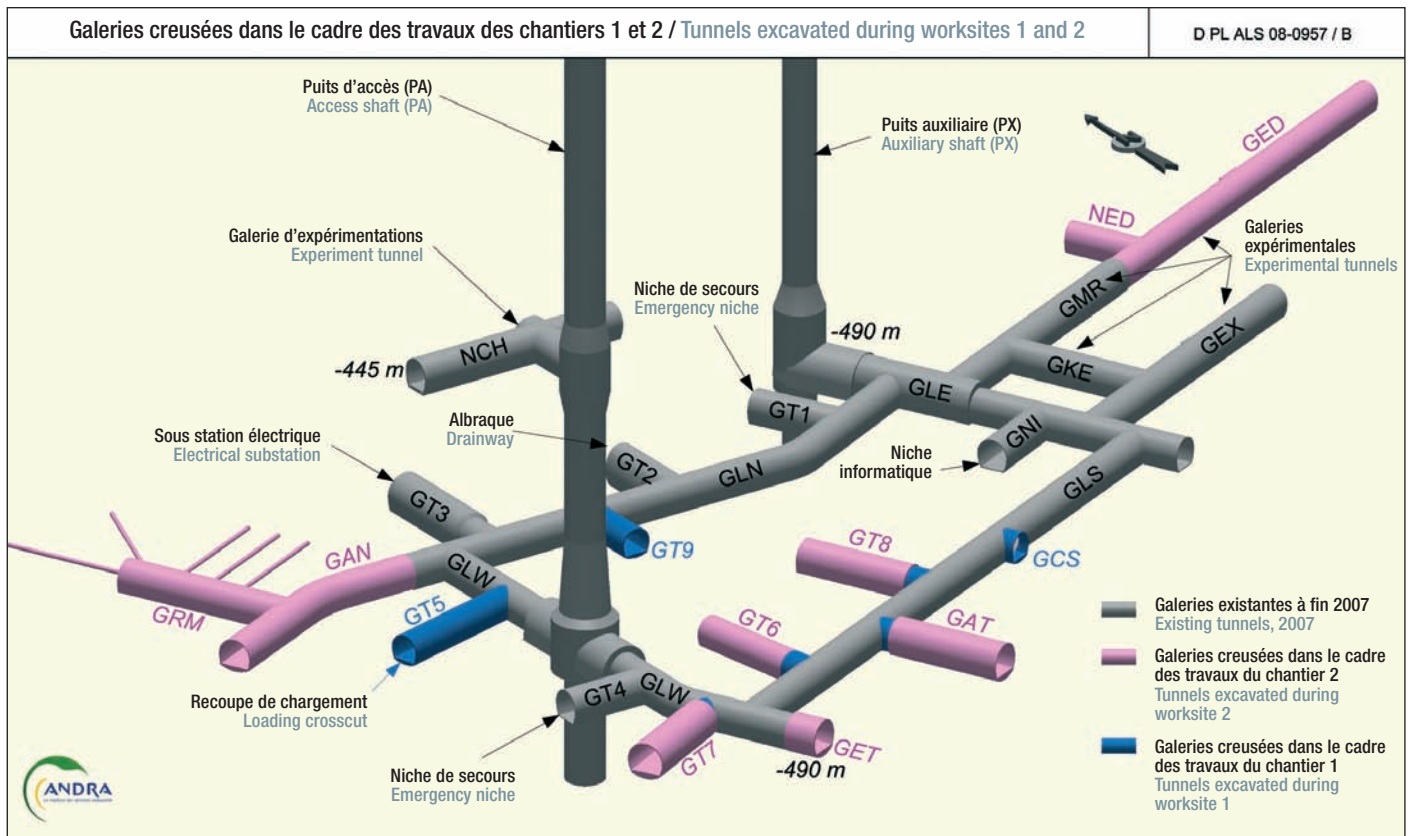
plan du laboratoire souterrain fin 2009 / Figure 2: plan of the underground laboratory as of the end of 2009
